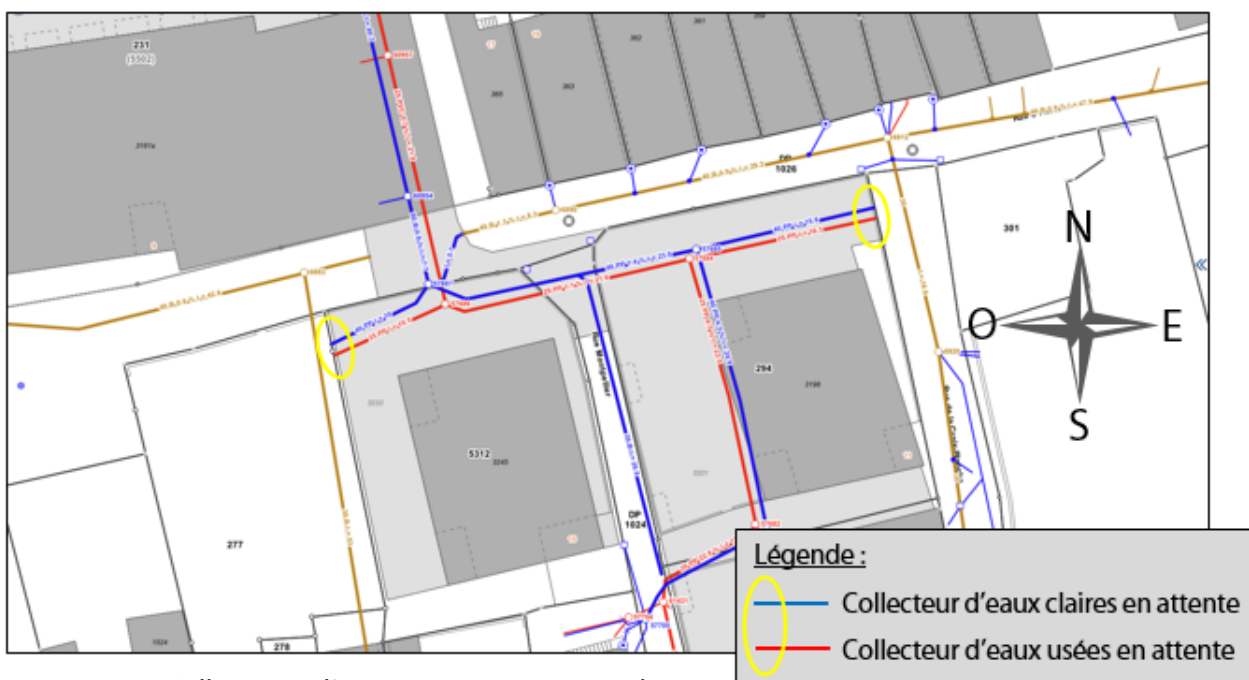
Collecteurs d'assainissement sous parking, en attente
